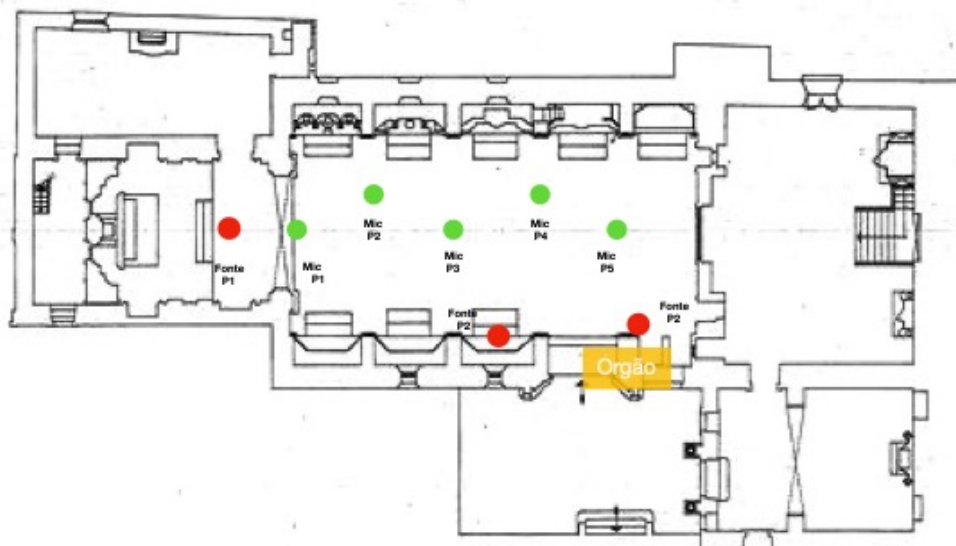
Planta da Igreja de Santa Clara com a posição da fonte sonora e do medidor.
